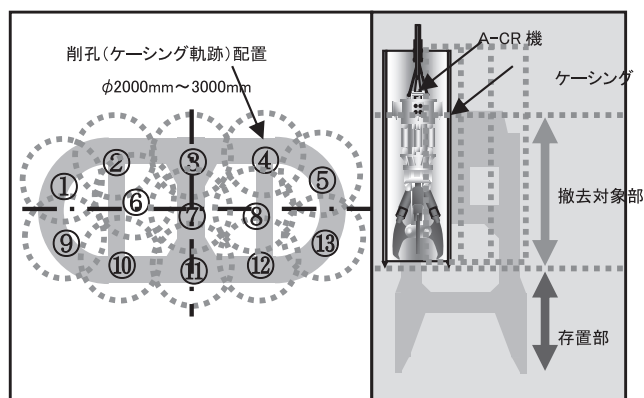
ケーソン施工時のラップ施工概念図 平面図(左) 断面図(右)
